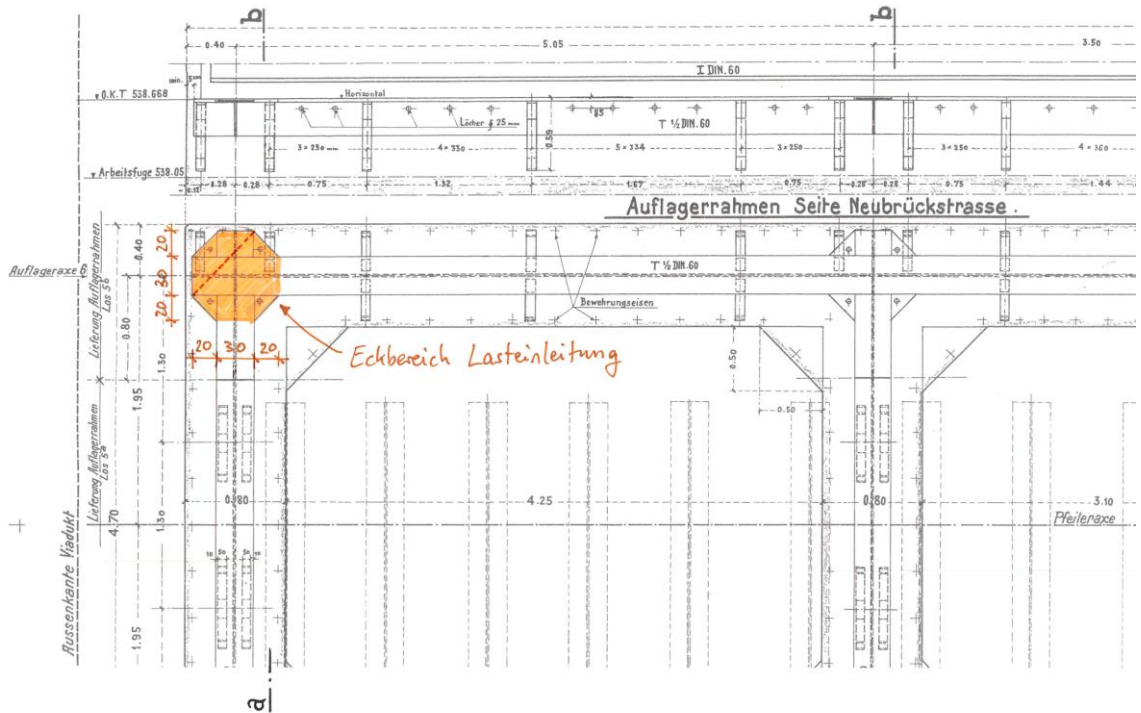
Grundriss des Auflagerrahmens im massgebenden Eck des Brückenpfeilers (Ausschnitt aus Plan 17.104-13)
